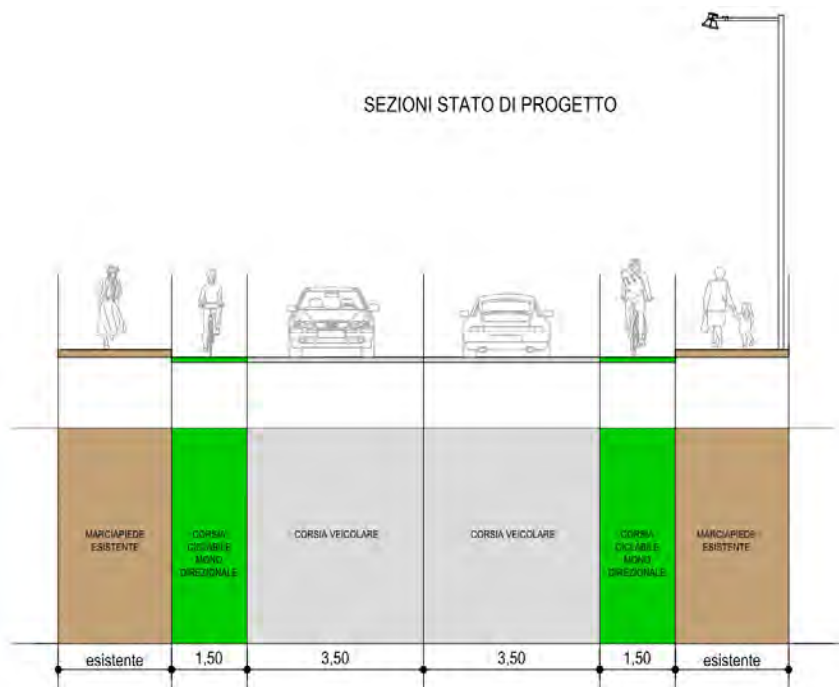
Sezione tipo di via Sanvito Silvestro: proposta di progetto
